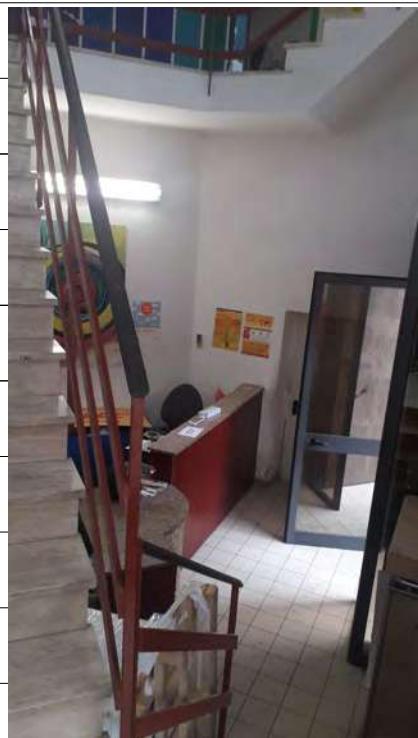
immagine interna del corpo scala di collegamento tra i piani terra, primo e secondo.
